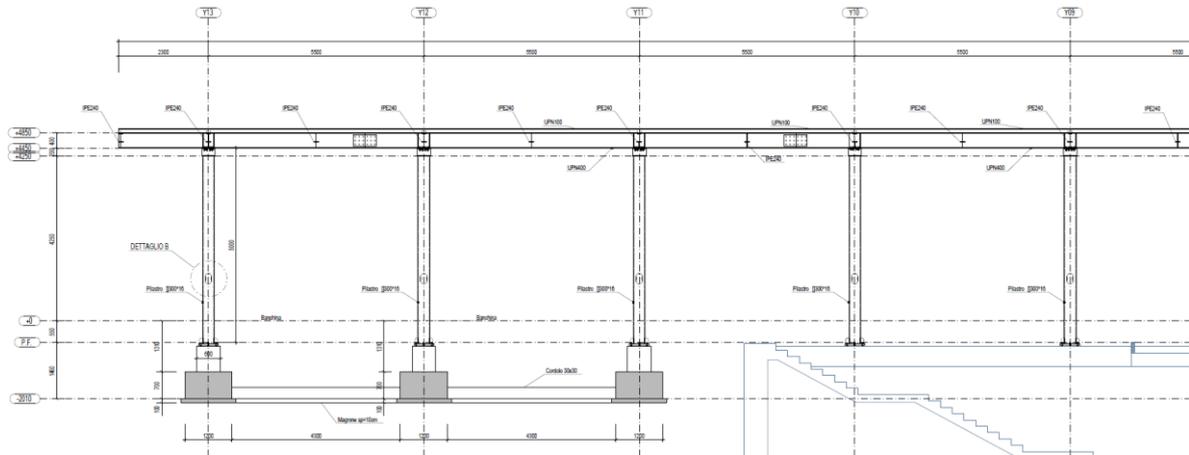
Pensiline – Stralcio Sezione longitudinale - Pensilina Sud
